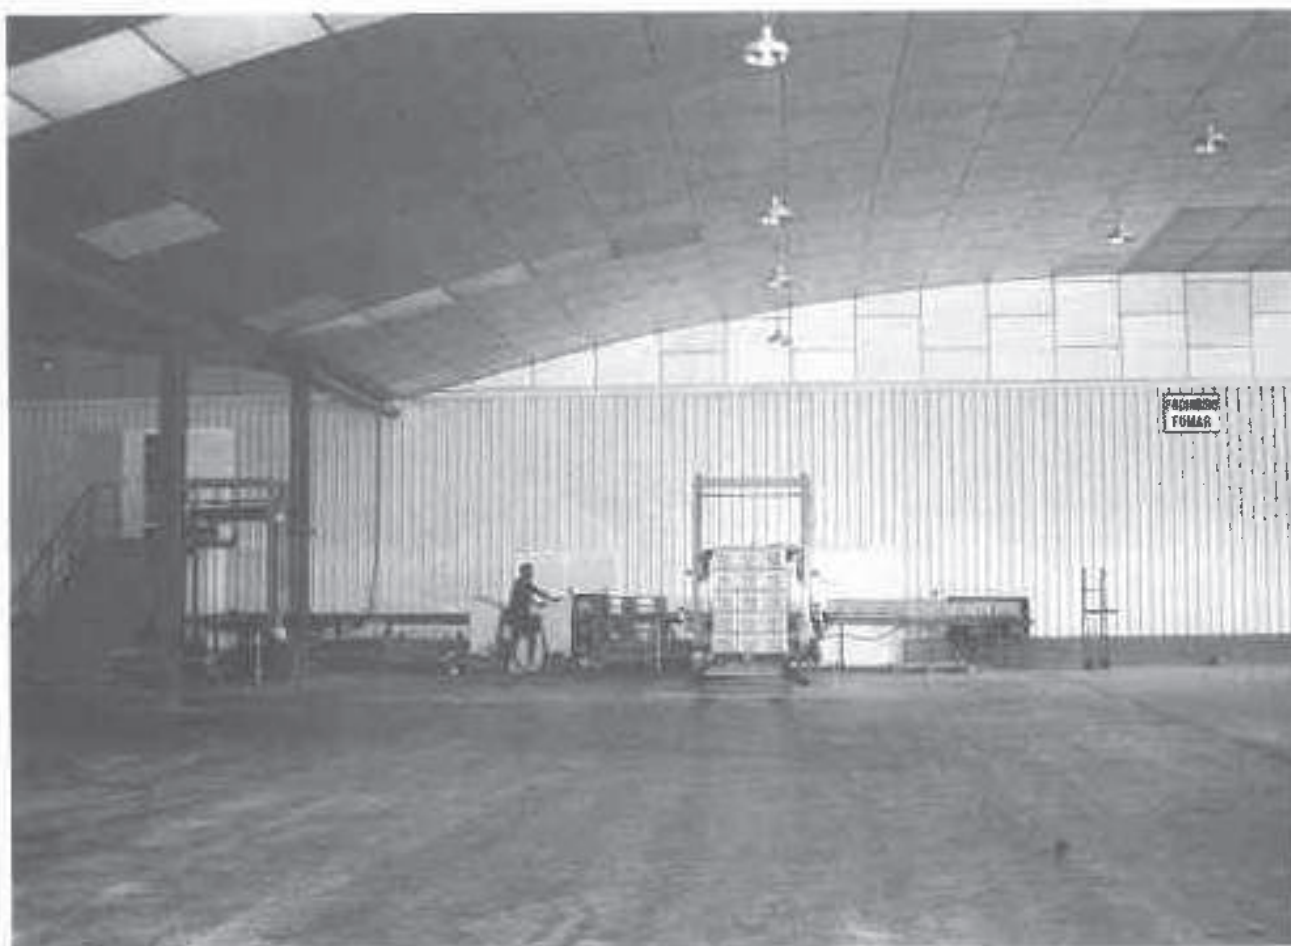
Paramento vertical construido con paneles aislantes de poliuretano, acabado en zona superior con placas aislantes de fibra de vidrio recubiertas exteriormente de papel aluminio, al igual que las utilizadas para el aislamiento de la cubierta. S. Coop. Gregal.
